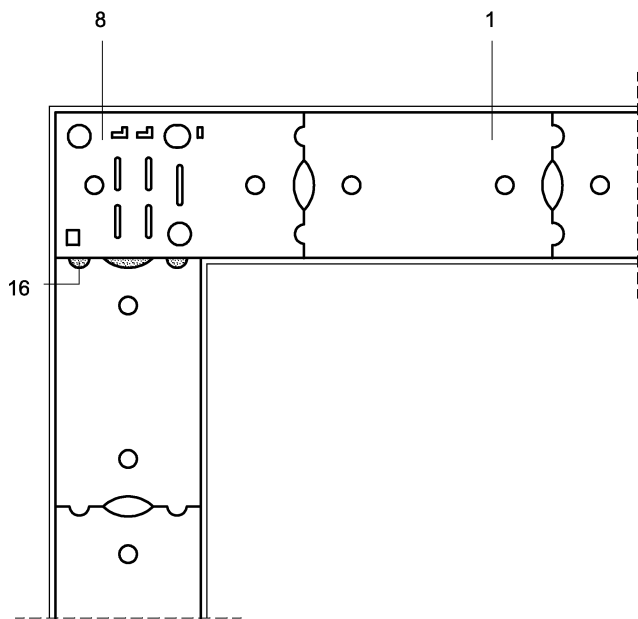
Encuentro en esquina hilada par. Muro portante. Bloque de longitud 50.
